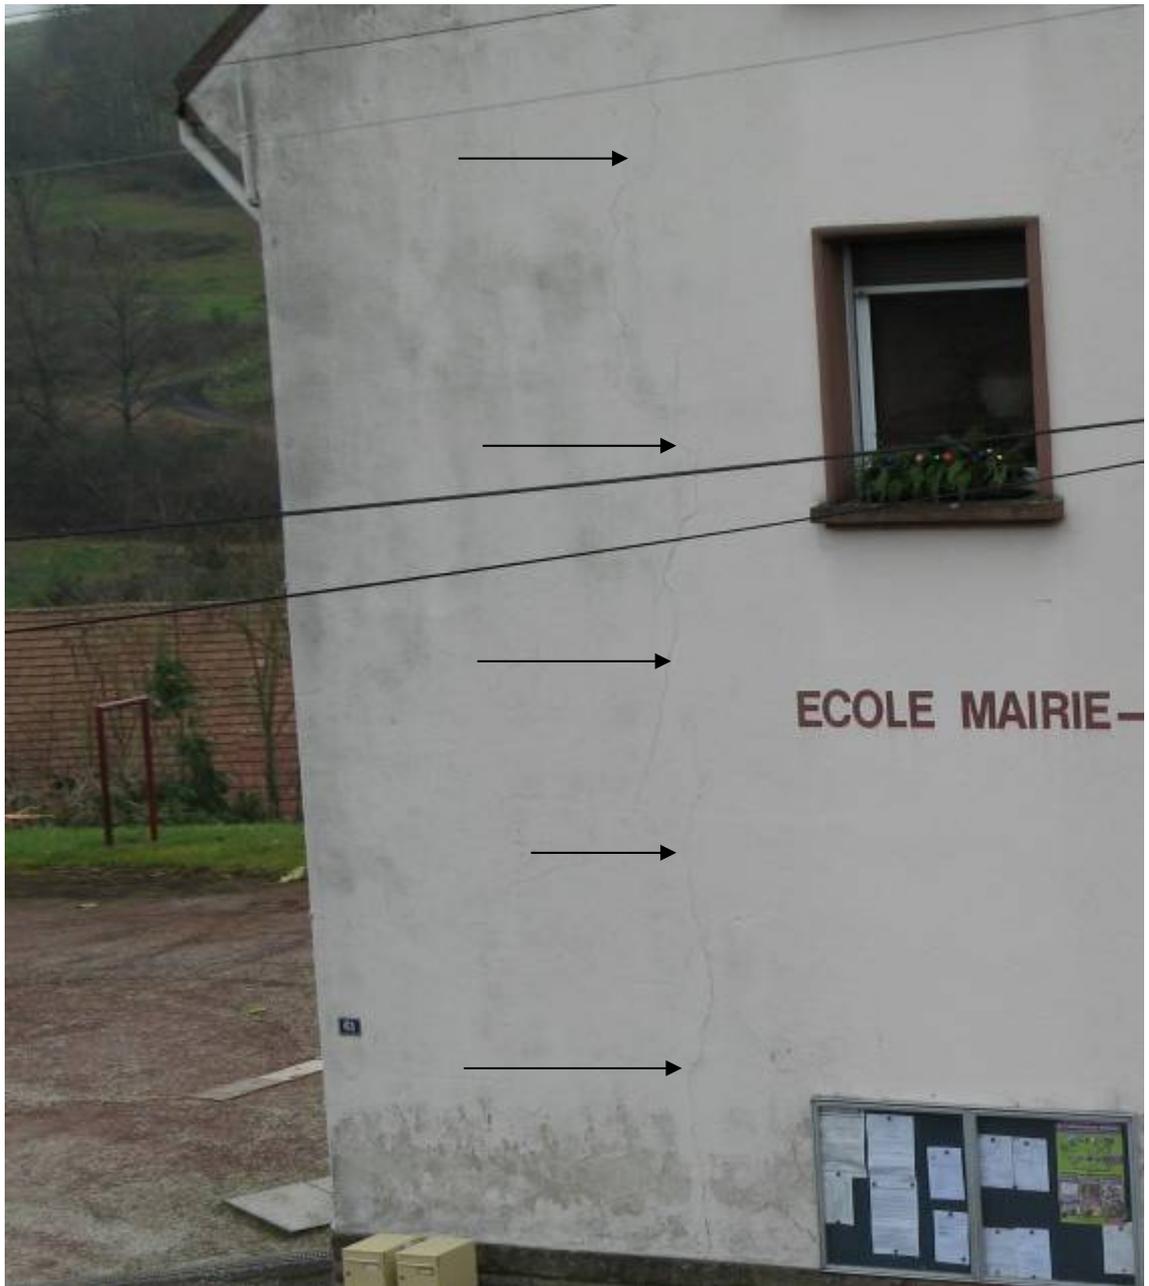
Fissures observées de haut en bas sur le bâtiment de la mairie.
